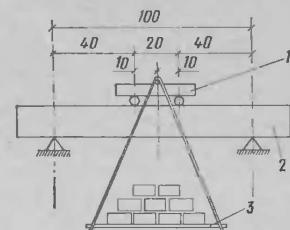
Схема испытания бетонных балок для определения в полевых условиях марки бетона
